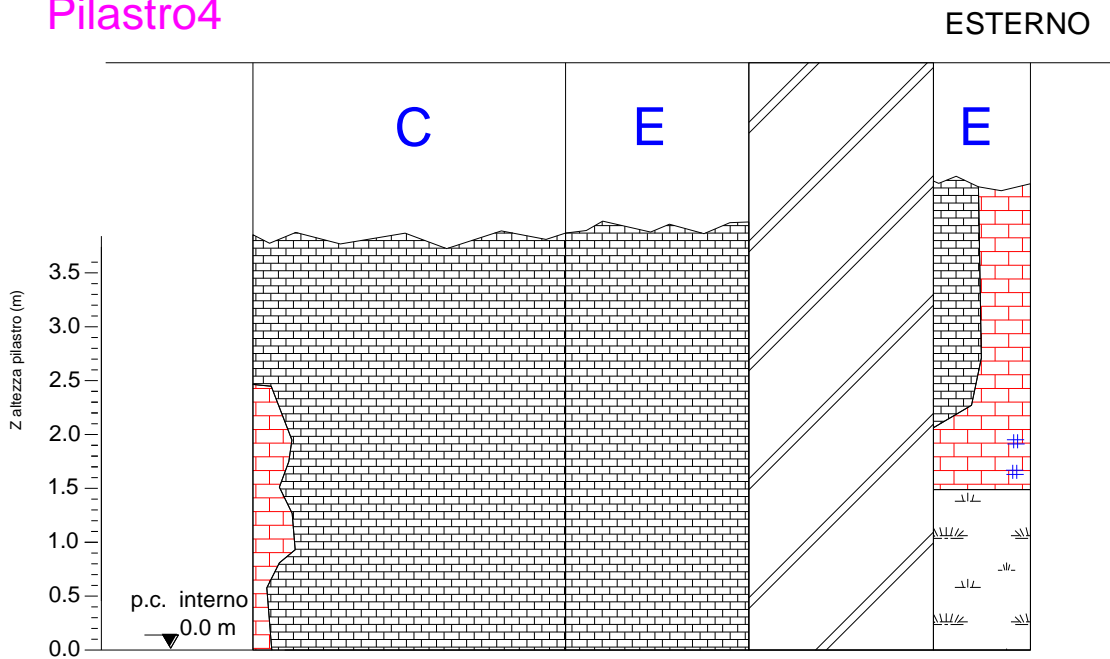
Ricostruzione paramento del Pilastro 4.
